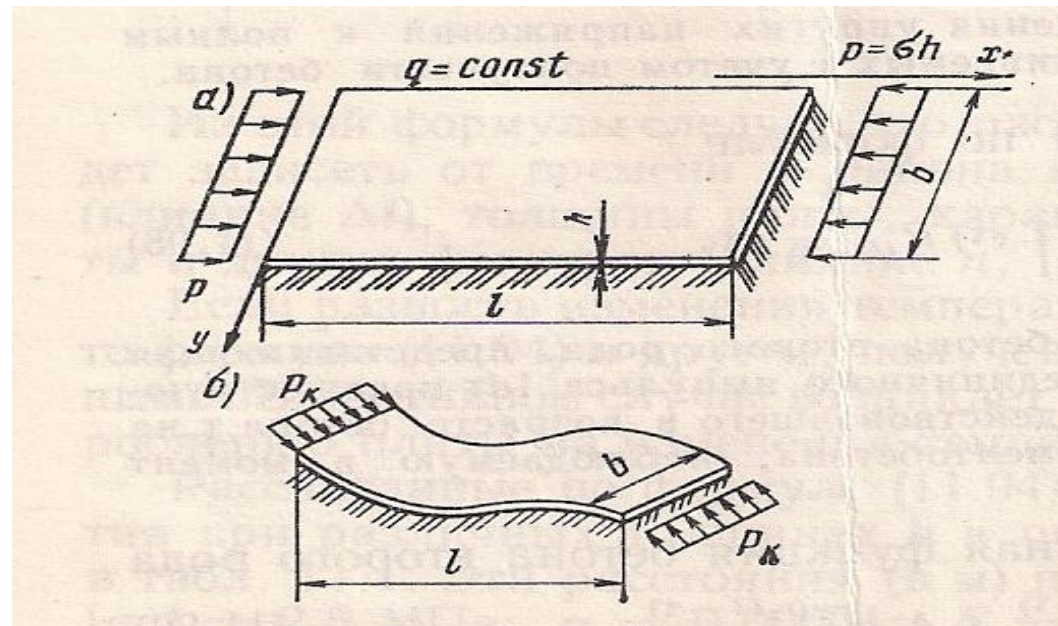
Схема к расчету температурного скачка: а – схема однополосного покрытия; б – схема цилиндрического изгиба полосы; b – ширина покрытия; h – толщина покрытия; P – нагрузка; l – длина рассматриваемого участка равная ∞
